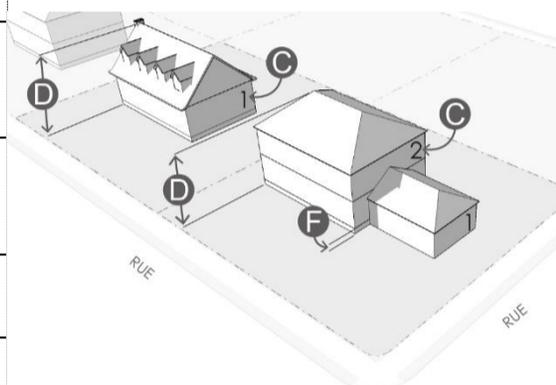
Hauteur d'un bâtiment et du plancher du rez-de-chaussée
